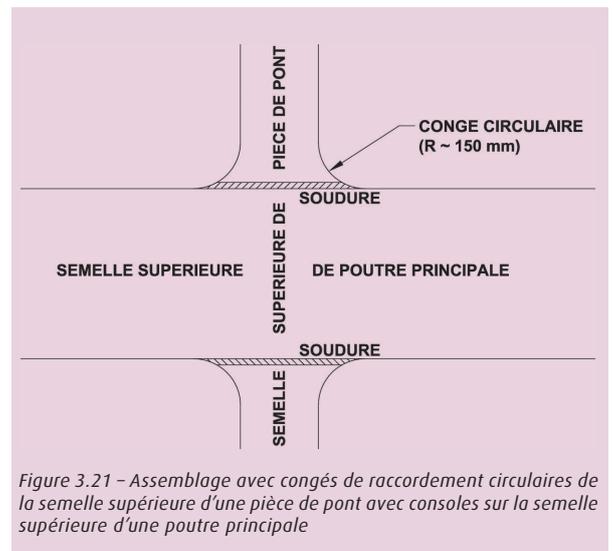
Assemblage avec congés de raccordement circulaires de la semelle supérieure d'une pièce de pont avec consoles sur la semelle supérieure d'une poutre principale
